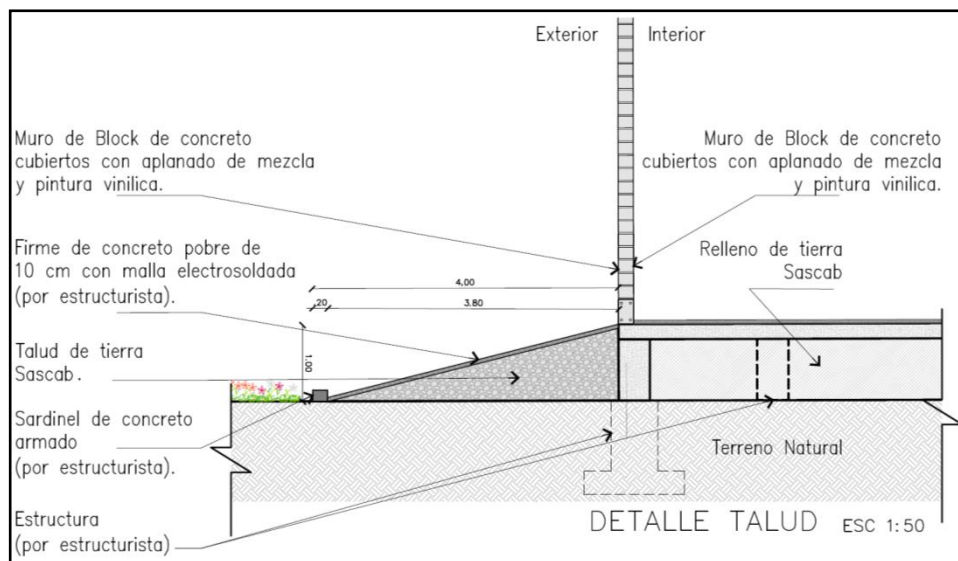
Detalles de la plataforma sobre la que se construirán los edificios del hotel.
